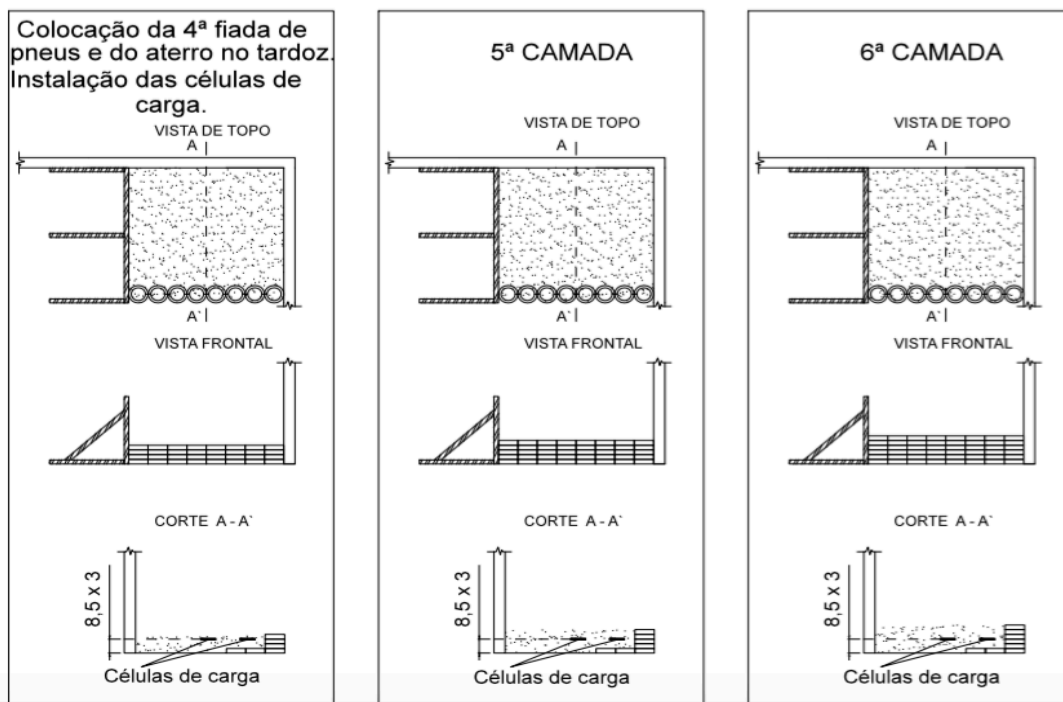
Faseamento construtivo da 4ª à 6ª camada.
